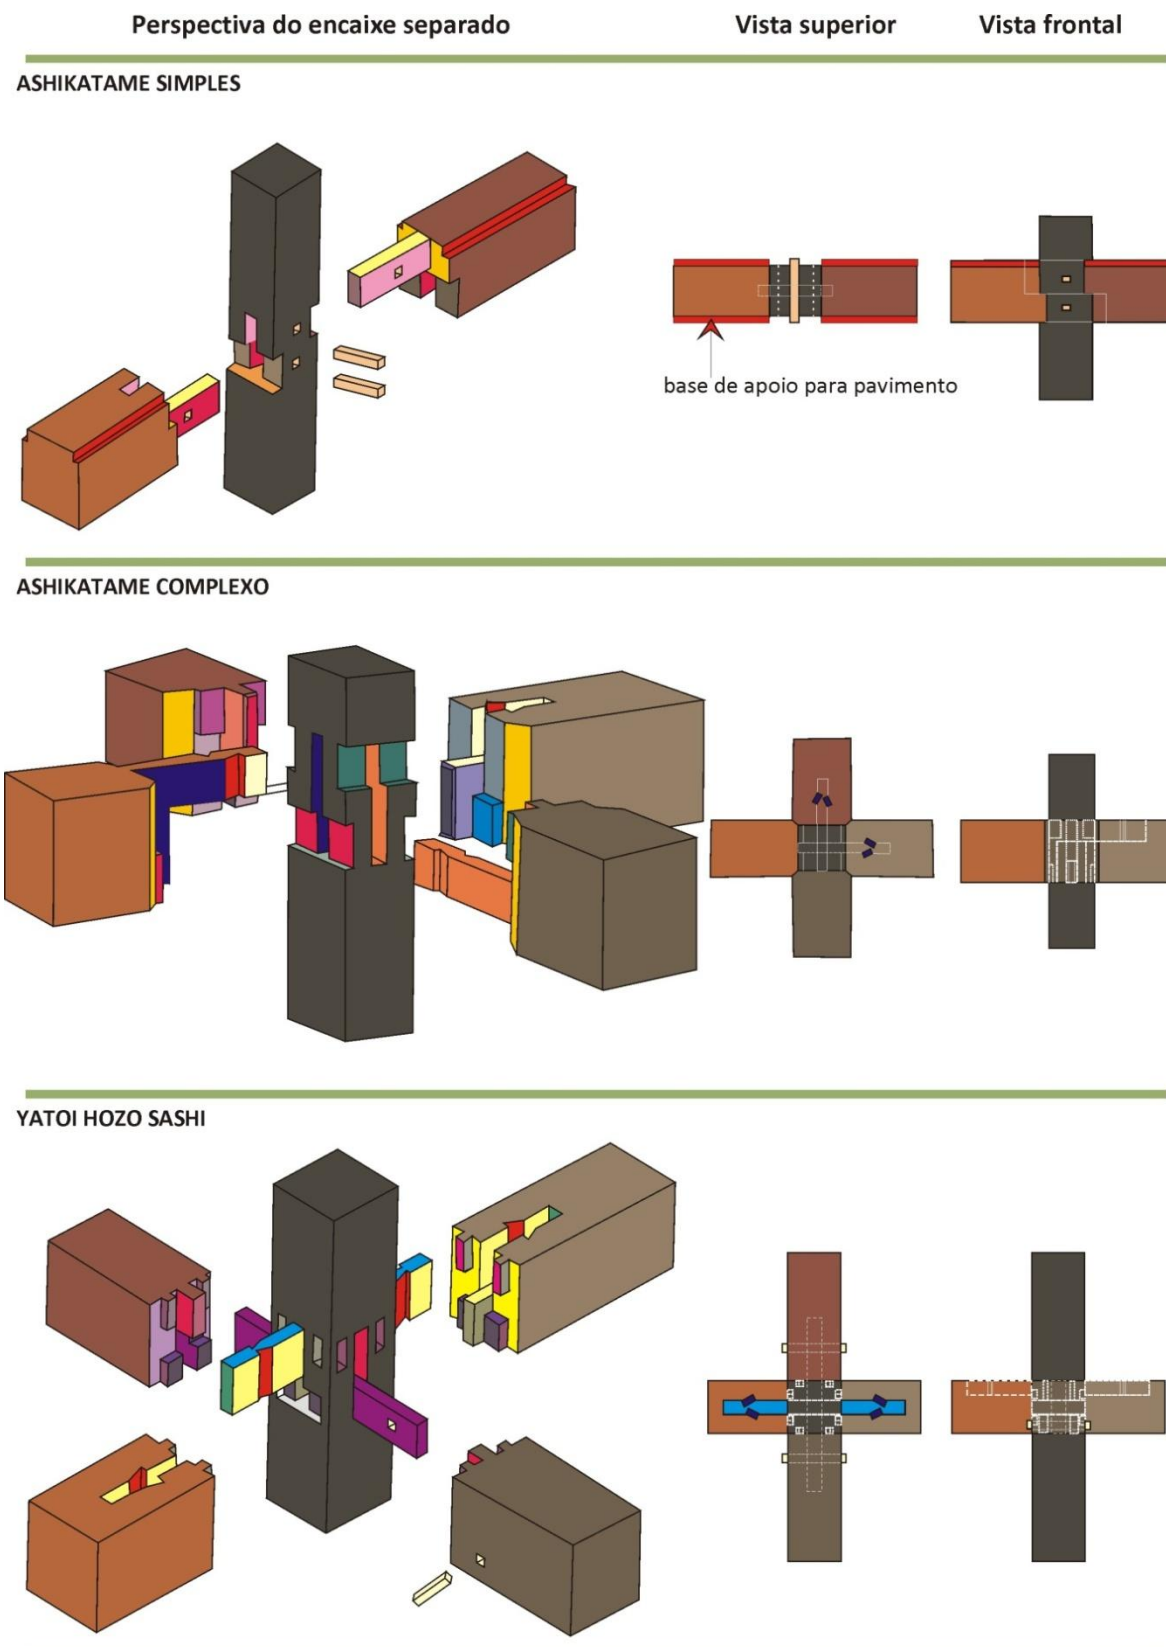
Encaixes tradicionais japoneses entre pilar e viga
